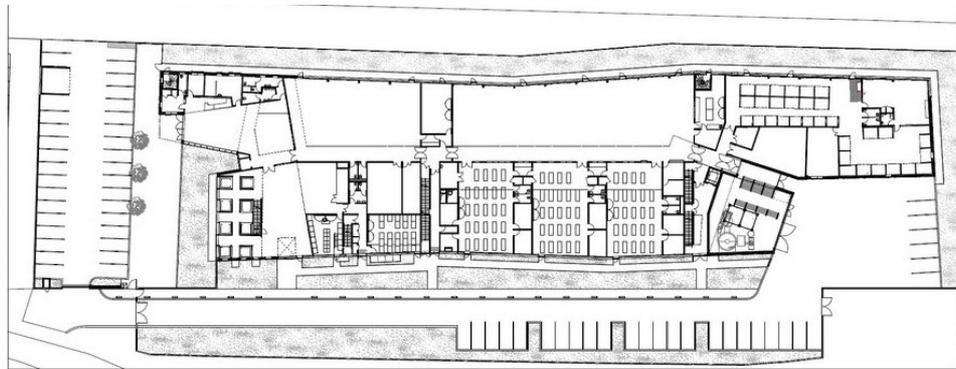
Pianta piano terra del Centro di formazione progettato ad opera degli architetti Brenac & Gonzalez a Gennevilliers, Francia, 2012, fonte www.archdaily.it
